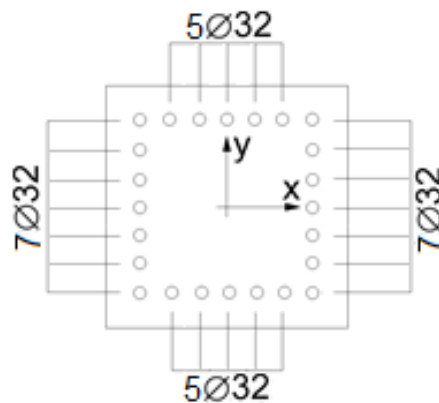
Configuração da armadura do pilar P122 - 60x60.
